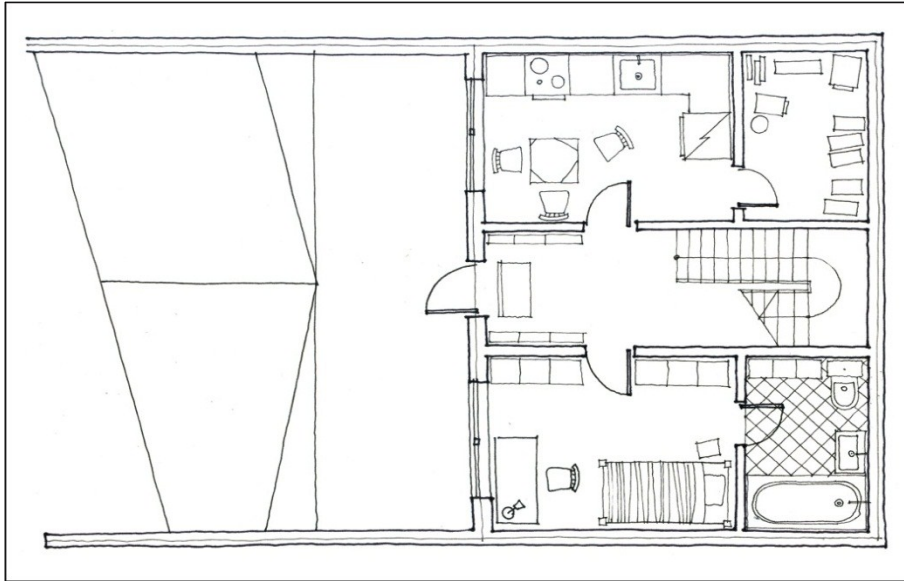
Quite time; Invisible house, Tokyo, Grundriss
